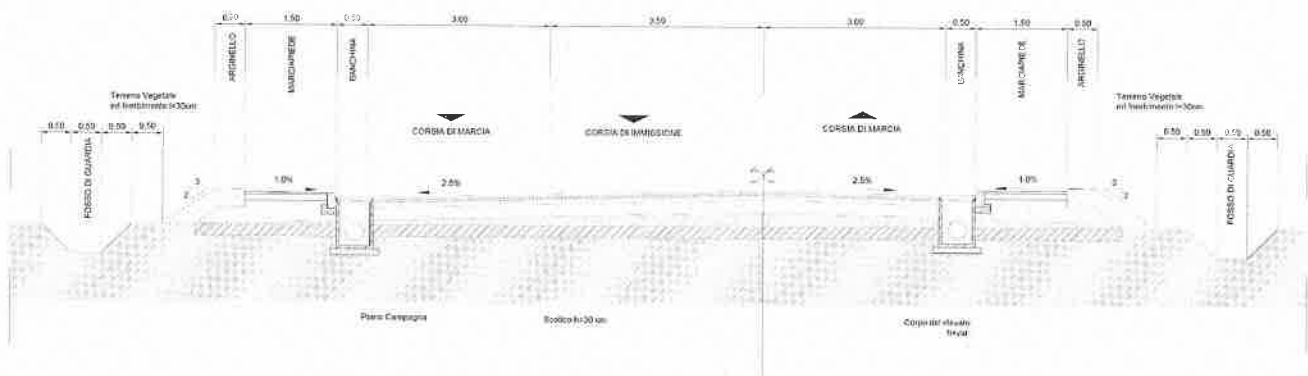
Sezione Tipo Rilevato tratto a 3 corsie compresa corsia di accumulo
